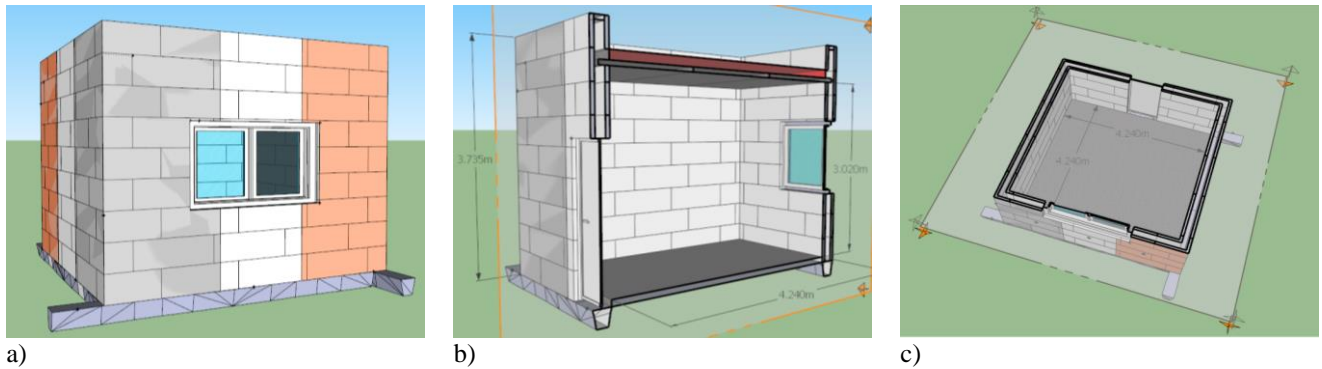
Modelação das células experimentais: a) Vista geral de sul-sudoeste; b) Corte vertical com orientação norte-sul; c) Corte em plano horizontal
